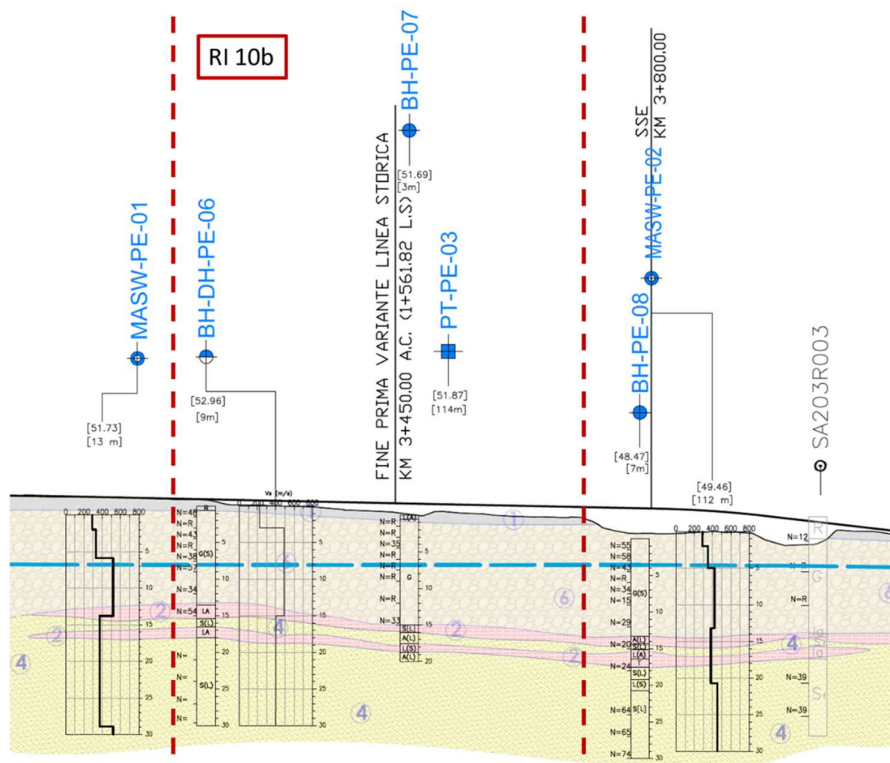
Profilo Geotecnico Rilevato RI10B, estratto dal Profilo Geotecnico Generale (Doc. Rif. [3])
